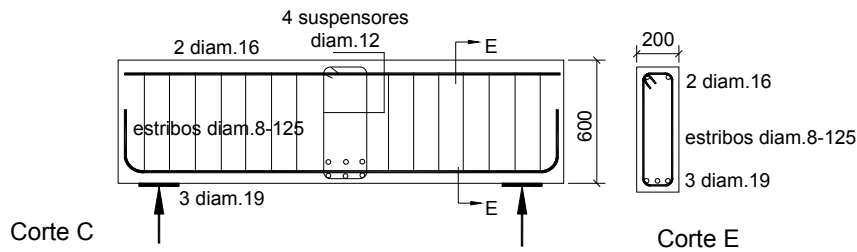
Vista y corte de la viga que soporta la viga principal (Nodo B) (1 mm = 0,03937 in.)
